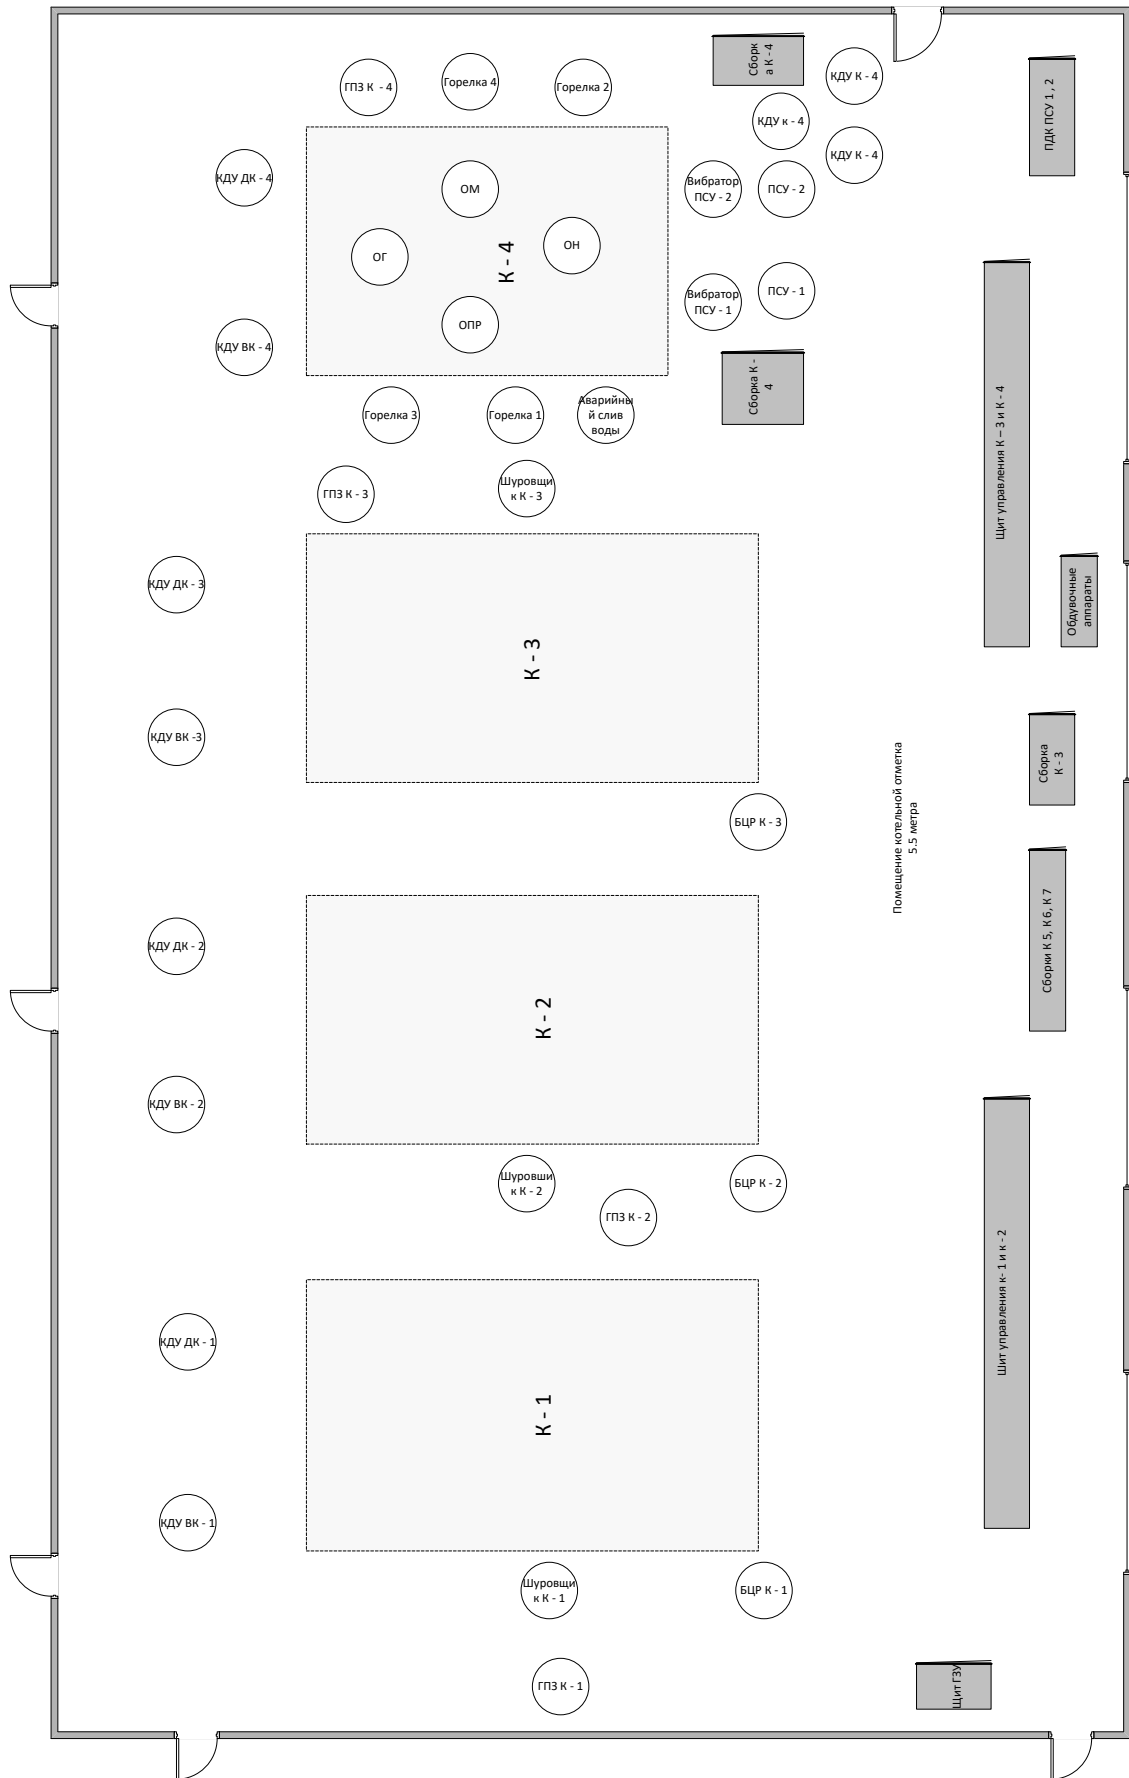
План помещений котельной на отм. 5.500 м с расстановкой оборудования
